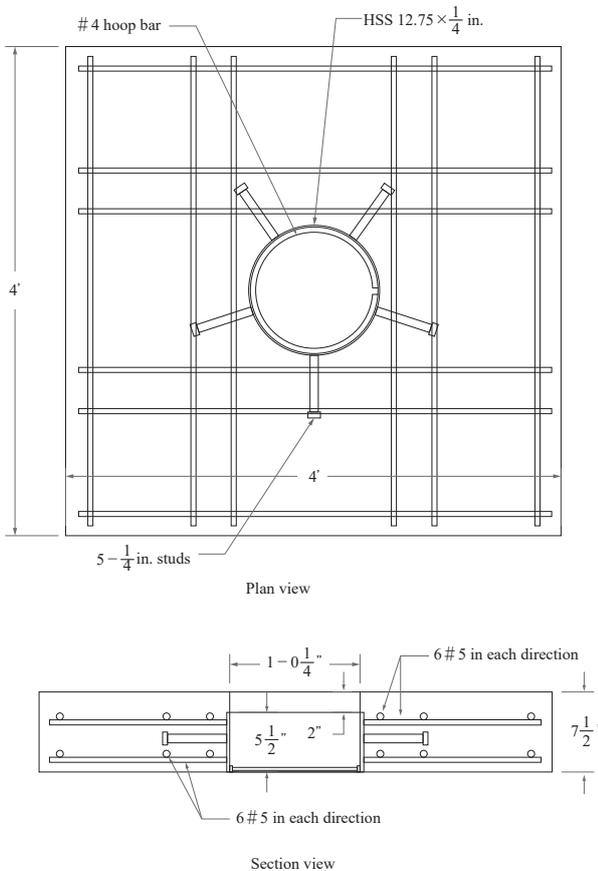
床版パネルの模擬試験を行うための MCSP 試験体の寸法と補強の詳細図（平面図，断面図）
